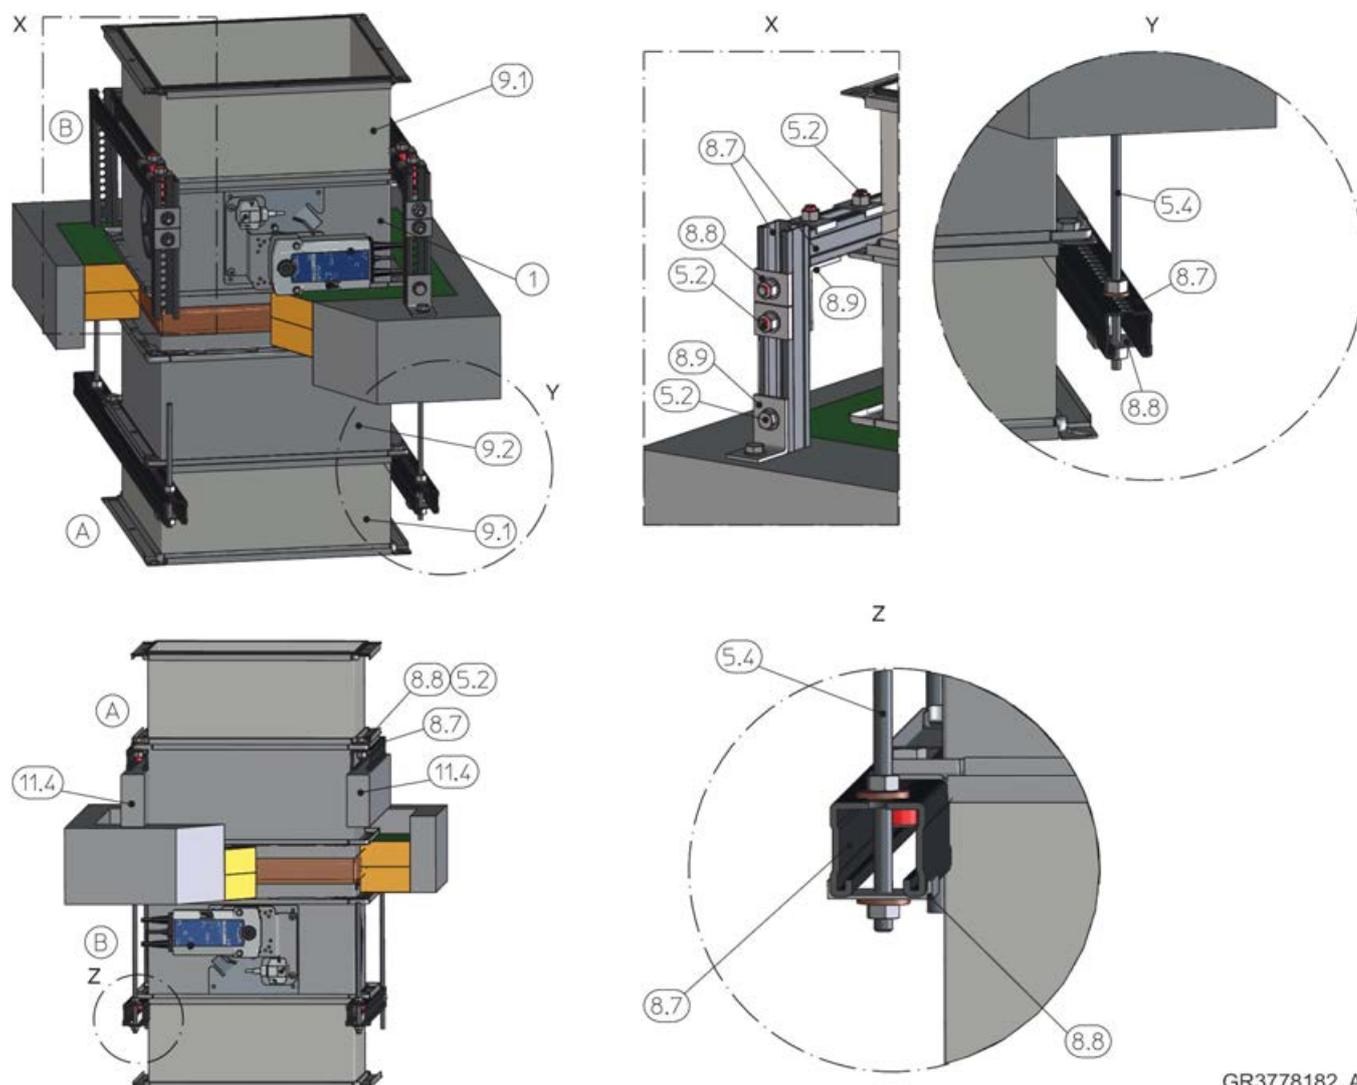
Fissaggio di FK2-EU, installazione in parete con un isolante antincendio
